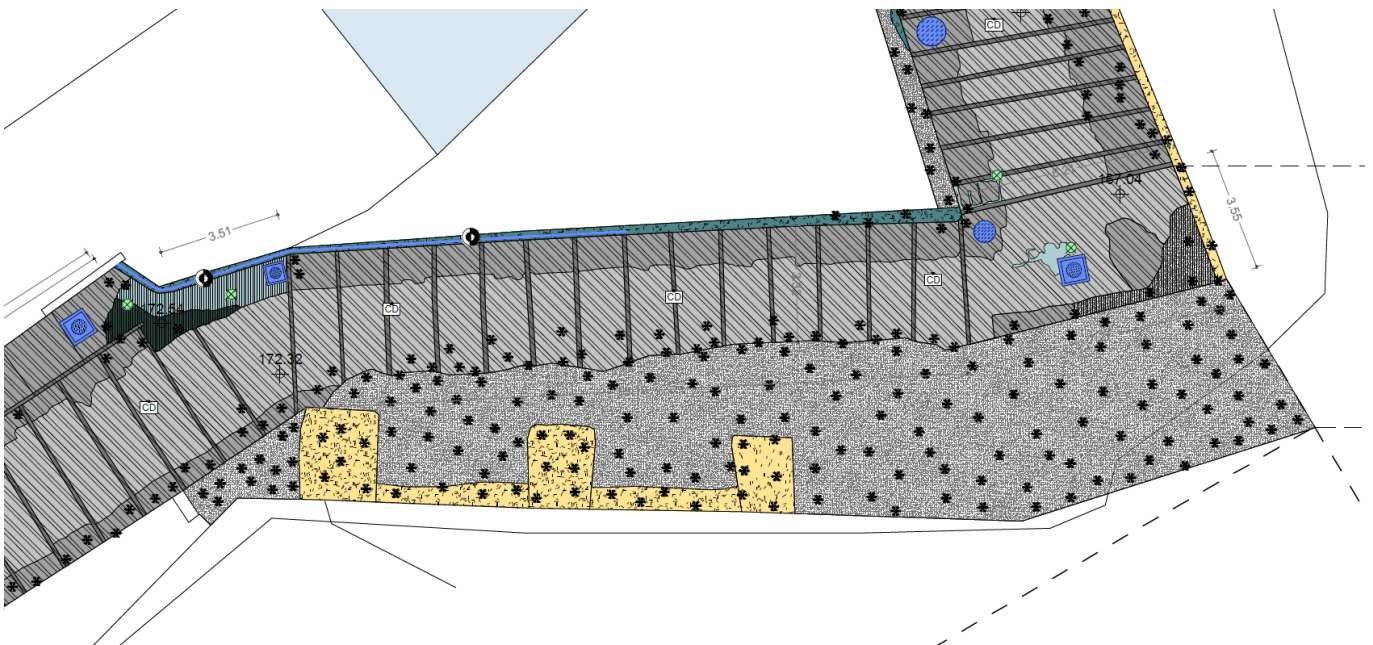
stralcio planimetrico dello stato di conservazione - (elaborato GKE015e/00)
